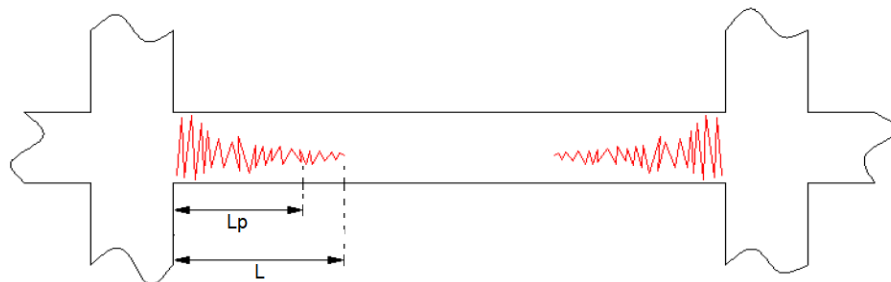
Daño en la viga. Fuente: Navarro & Fernández (2006)
